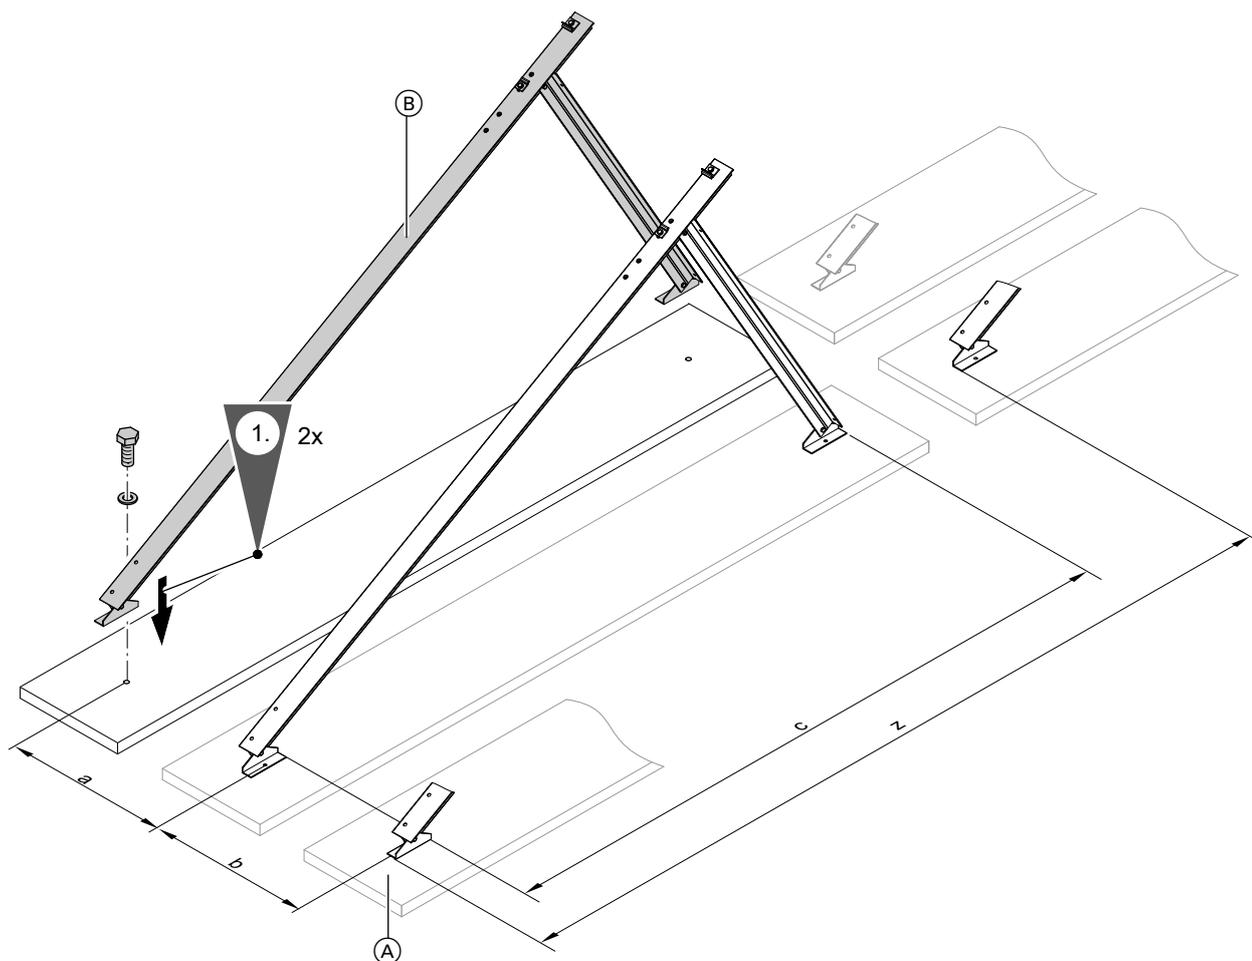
BefestigungsfüÙe als Bohrschablone benutzen.
